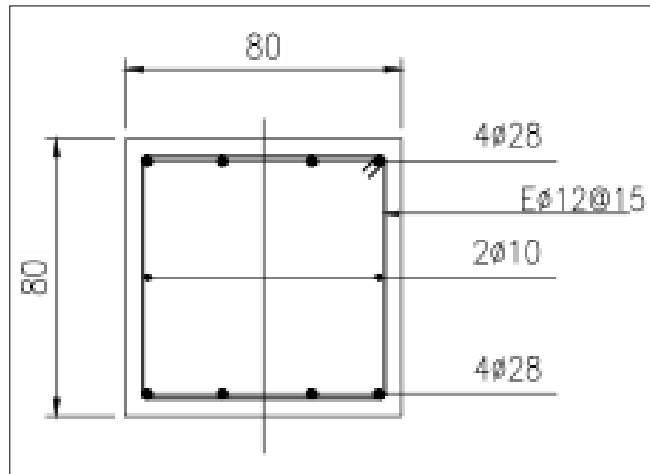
Armadura pilas 10 y 30, plano Ferrara Ingeniería y Construcción.
